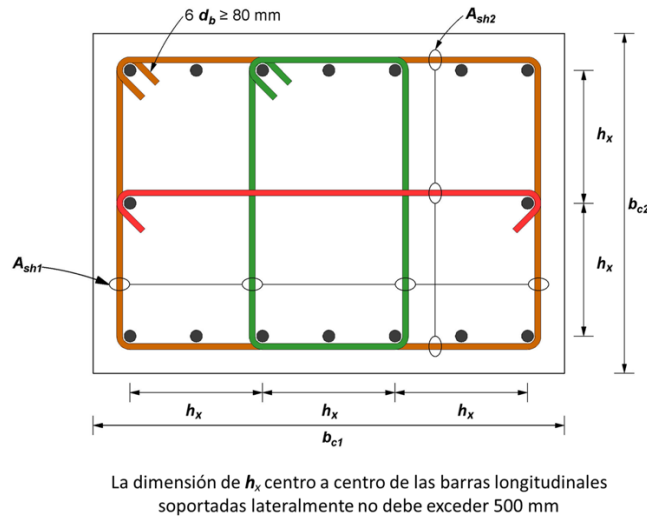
Ejemplo del refuerzo transversal en columnas (adaptada de ACI CODE-318-19)
